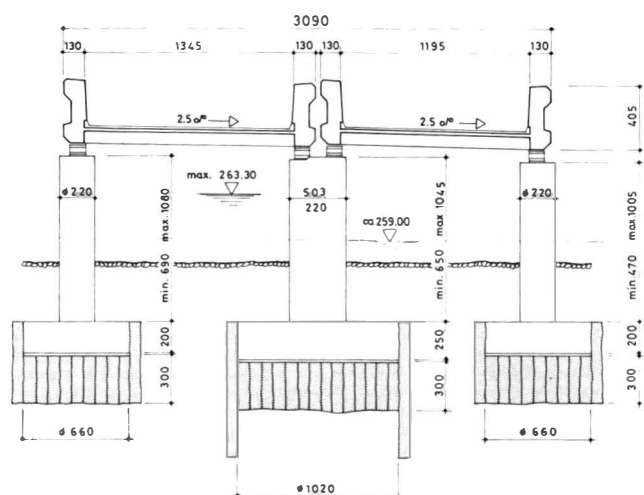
(oben). Detail Längsschnitt - Détail profil en long - Detail of longitudinal profile - Dettaglio profilo longitudinale
